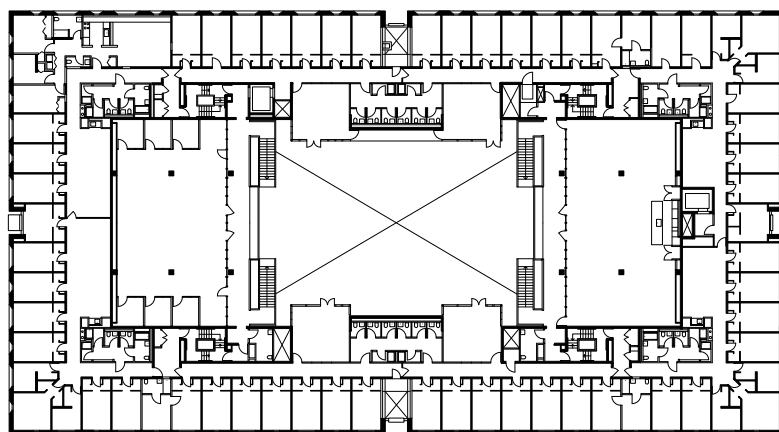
Grundriss Regelgeschoss [© BF Vario]
